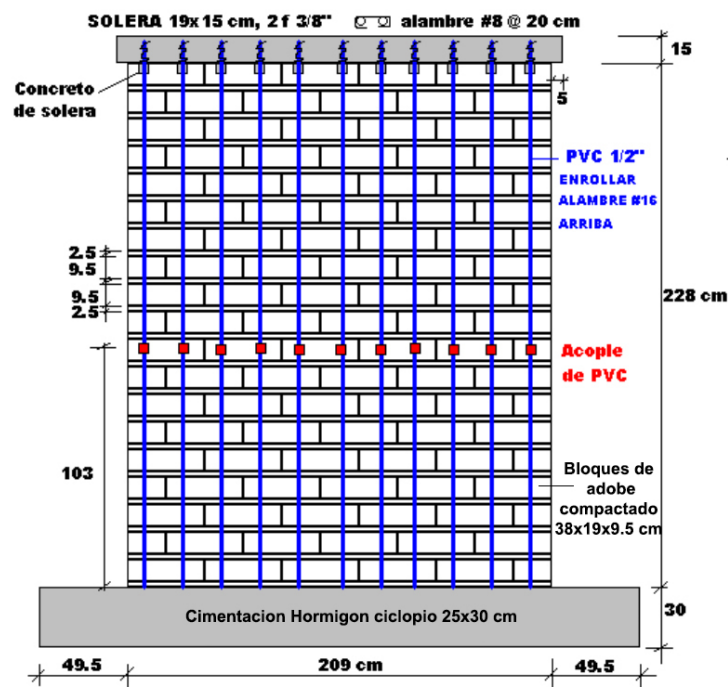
Muro reforzado usando tubos PVC, esquema de armado.
